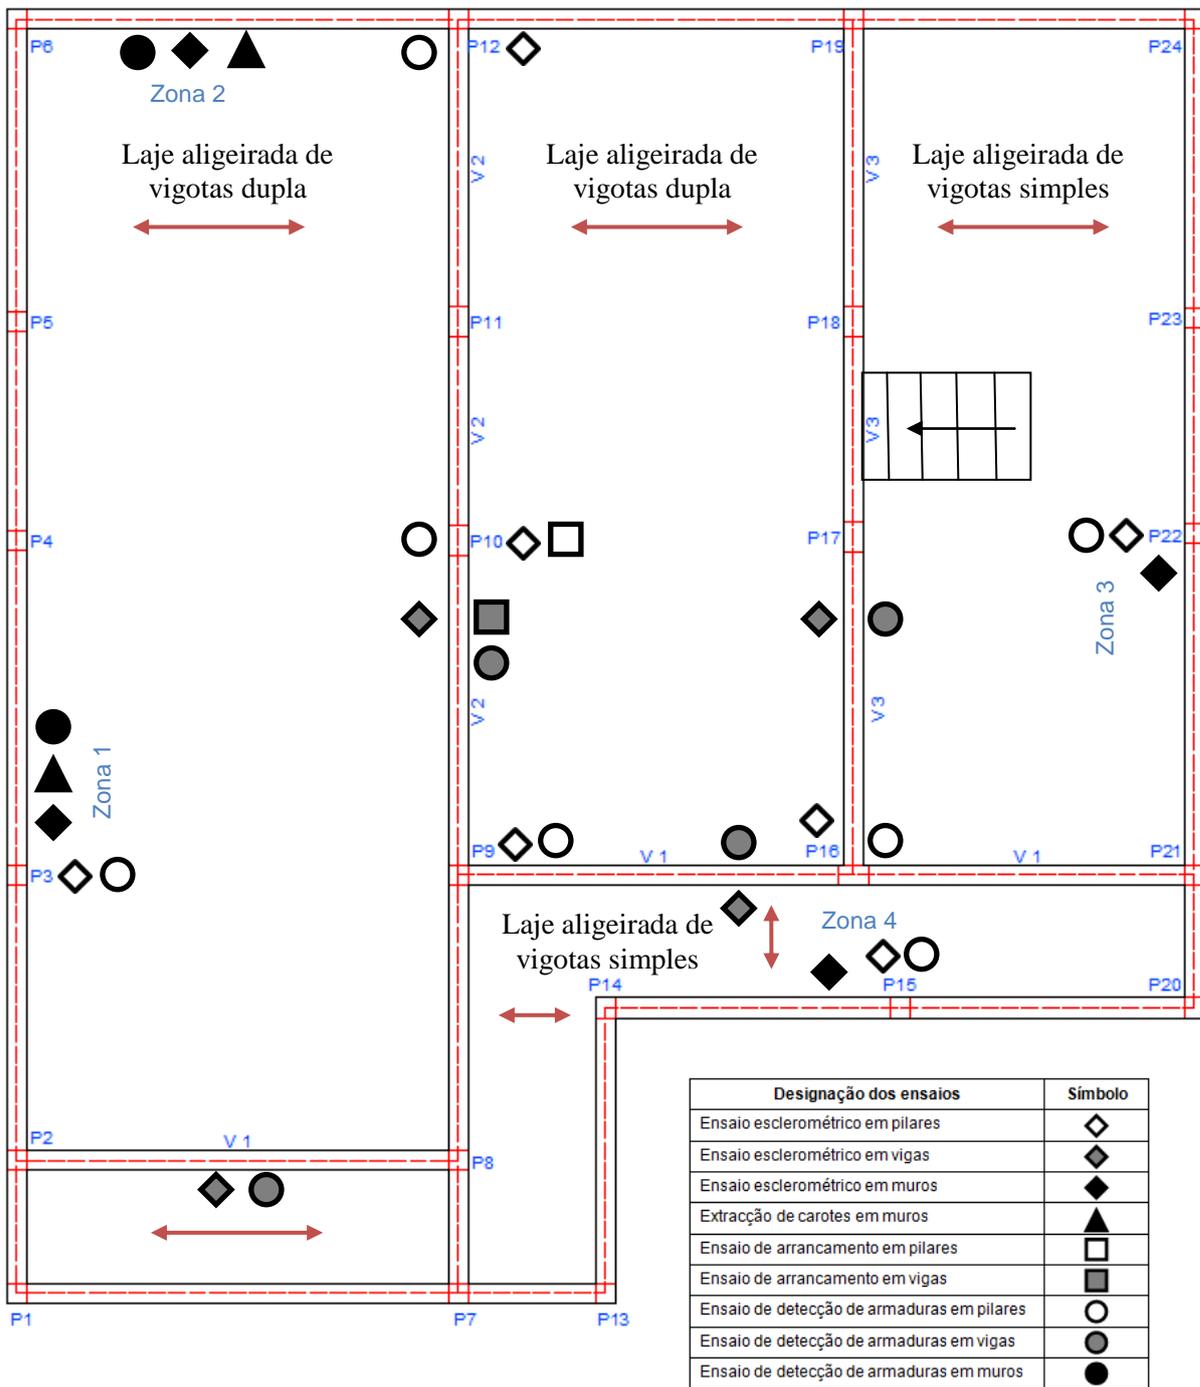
Planta estrutural do R/C (localização dos ensaios)
